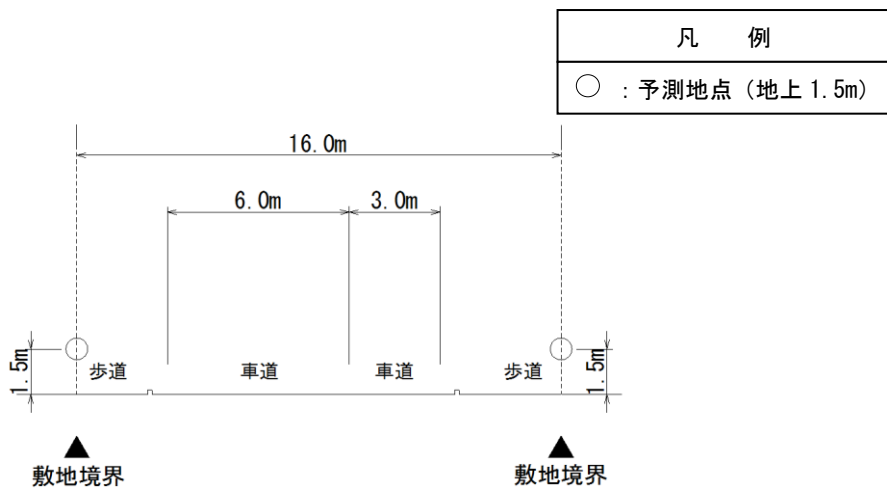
(3) 予測断面図 (C. 一般国道464号 (1))
